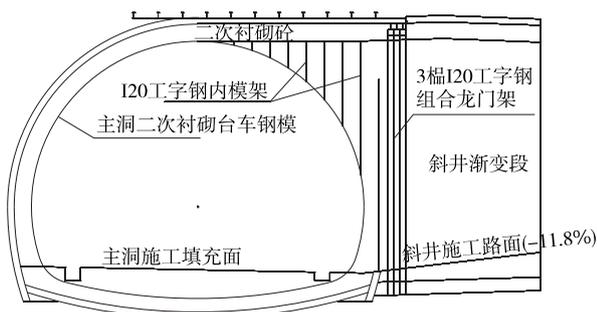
正洞交叉口处二次衬砌施工示意图(单位:cm)
